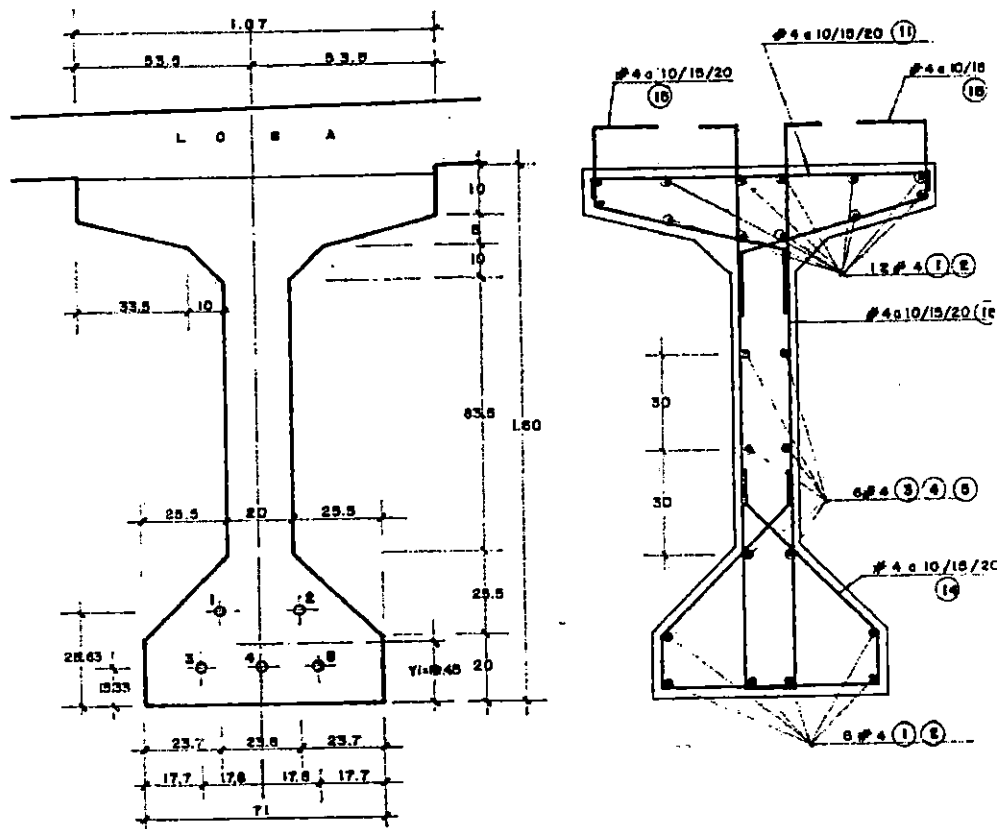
SECCION 2 - 2 DE VIGA.
